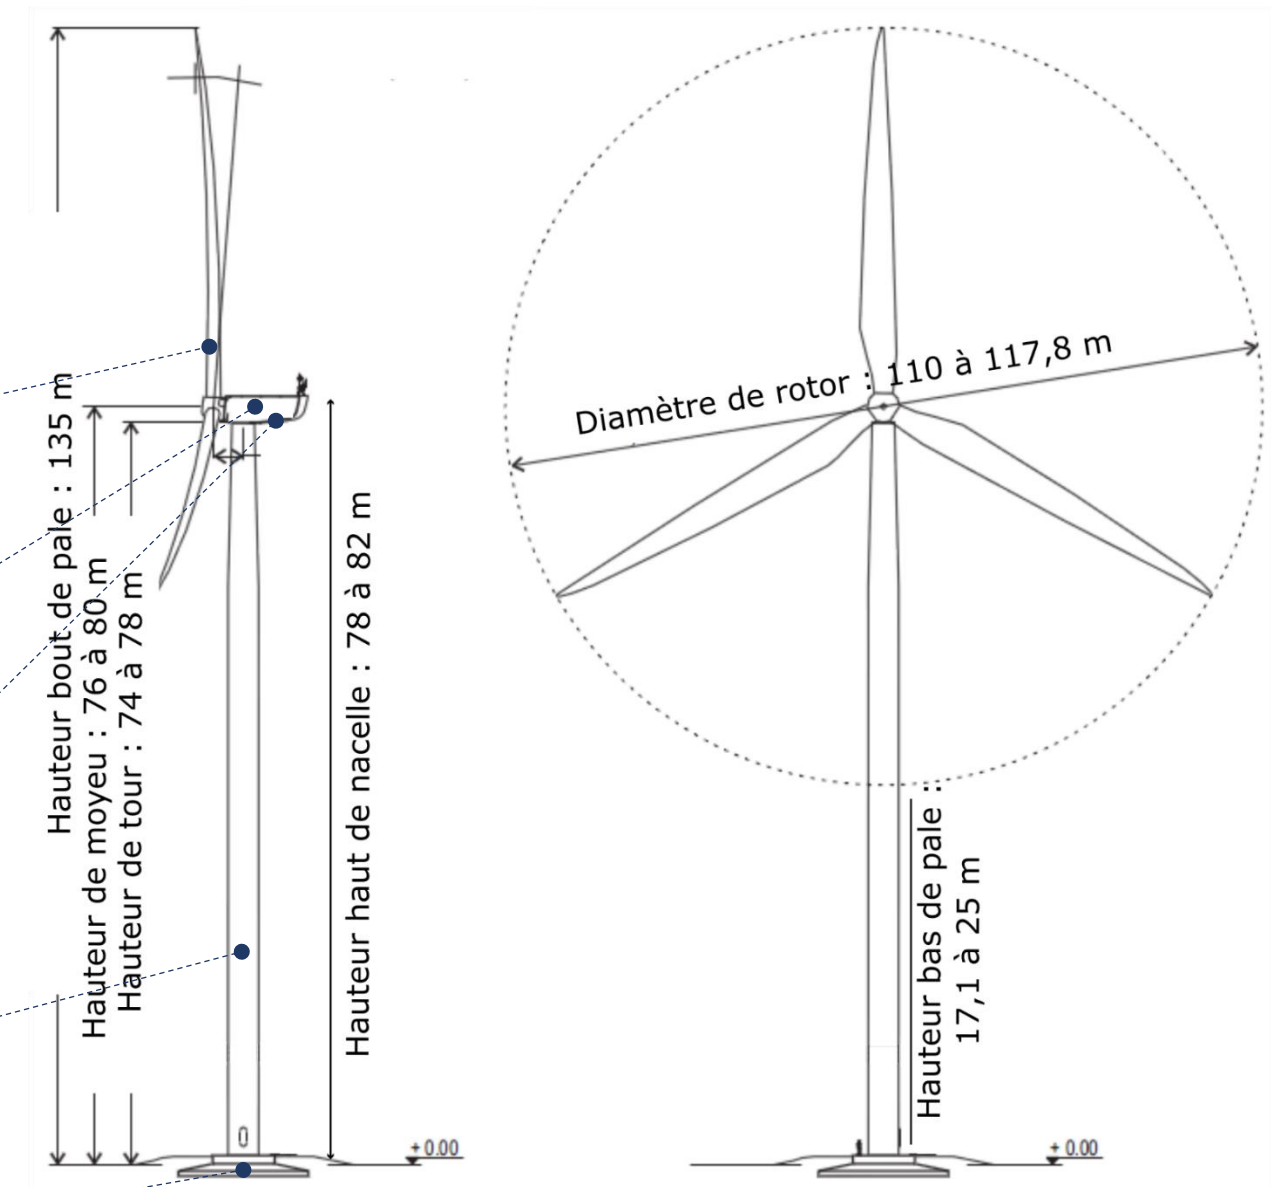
Plan d'élévation du gabarit-type d'éolienne prévu
